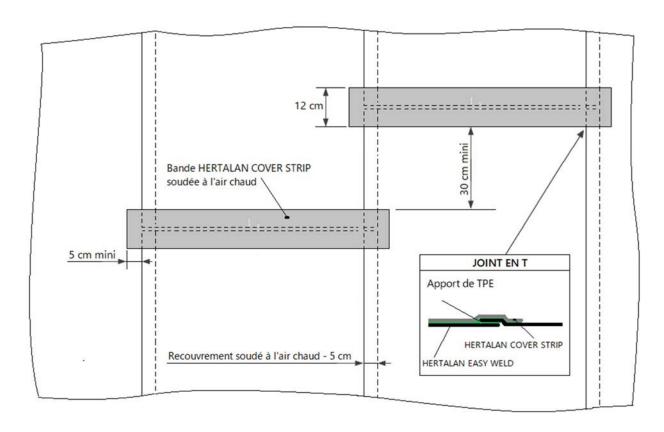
HERTALAN EASY WELD, joints décalés avec bande de pontage soudée
